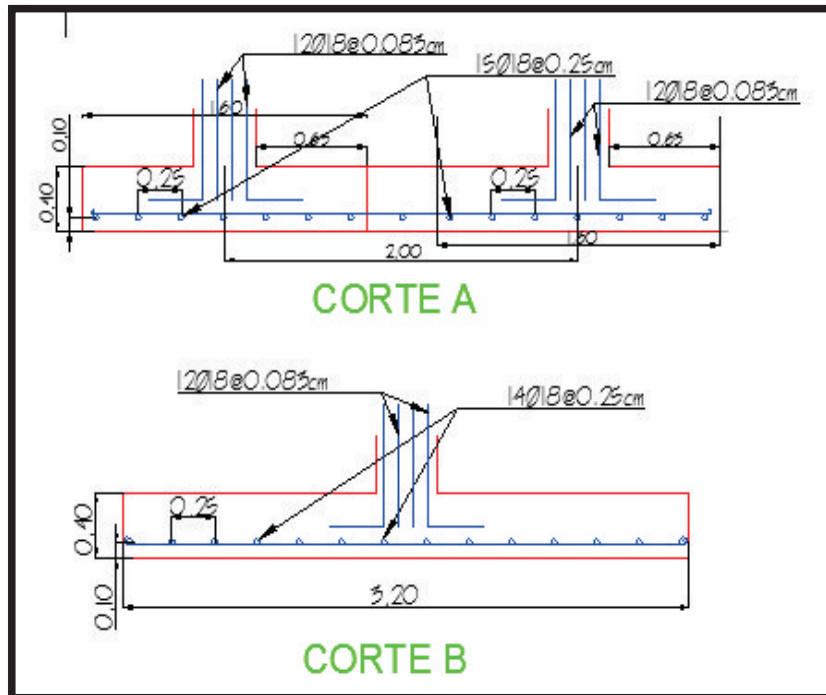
Diseño a flexión, armado de varillas en la dirección x y, corte A y B
